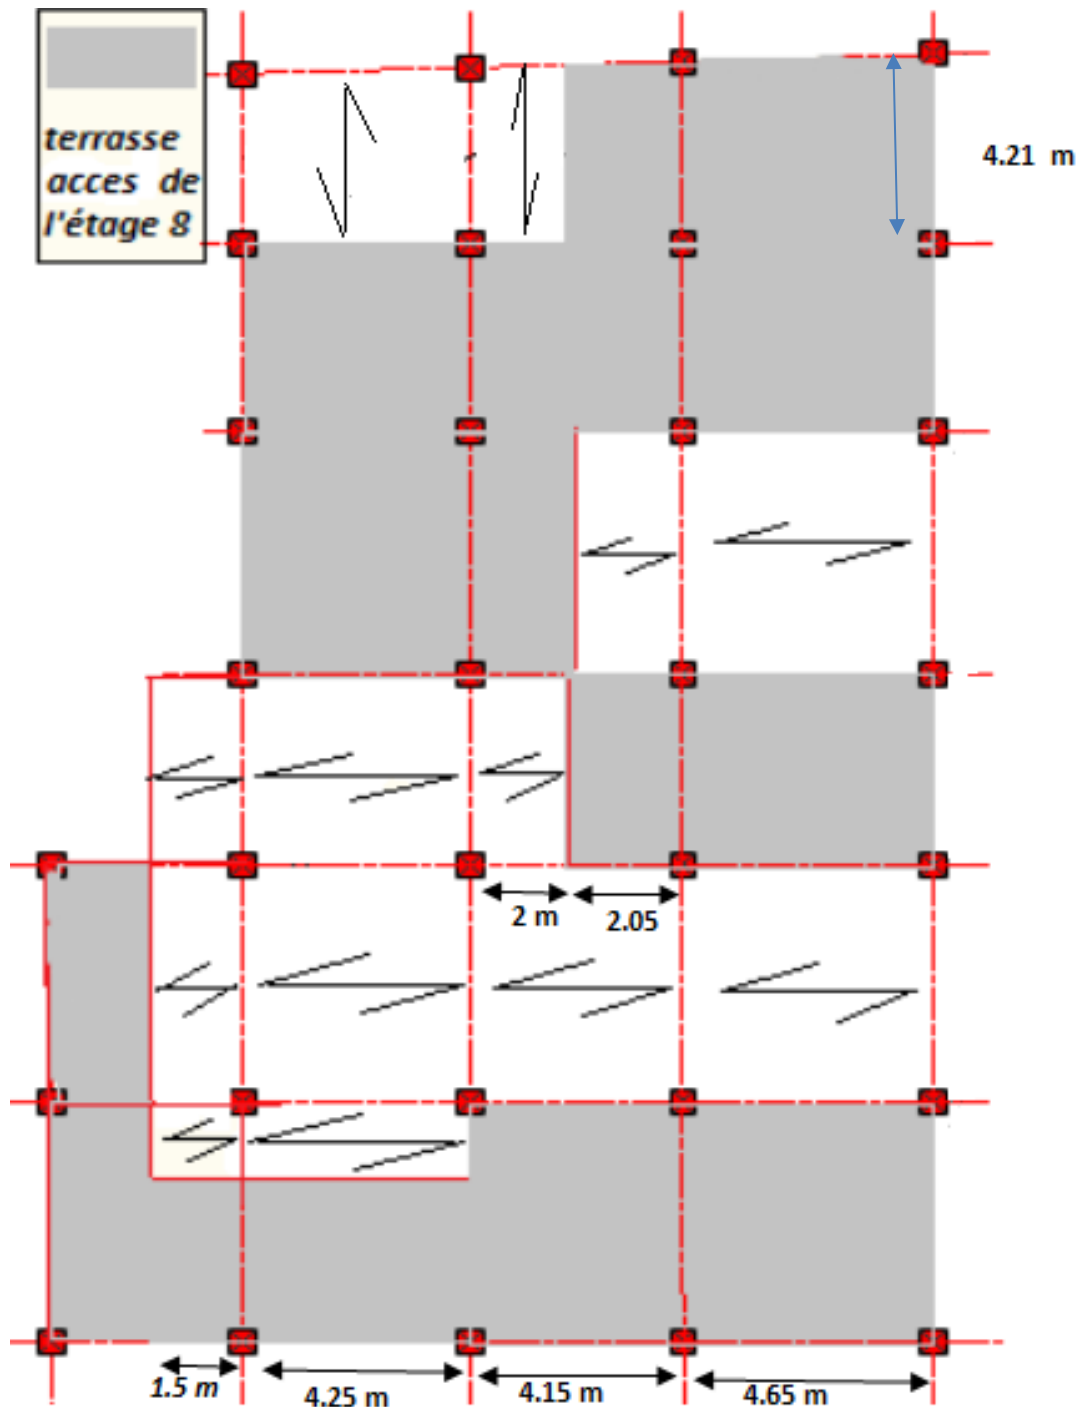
Schéma de disposition des poutrelles pour la terrasse inaccessible de l'étage 8
